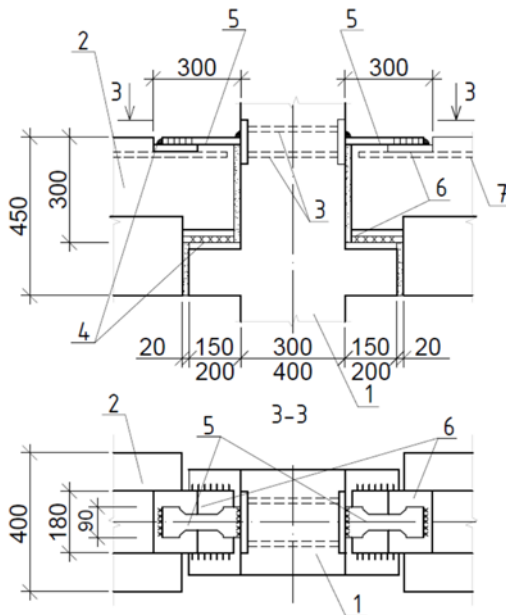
Конструкция узла опирания ригеля на колонну в унифицированном каркасе (серия 1.020):
